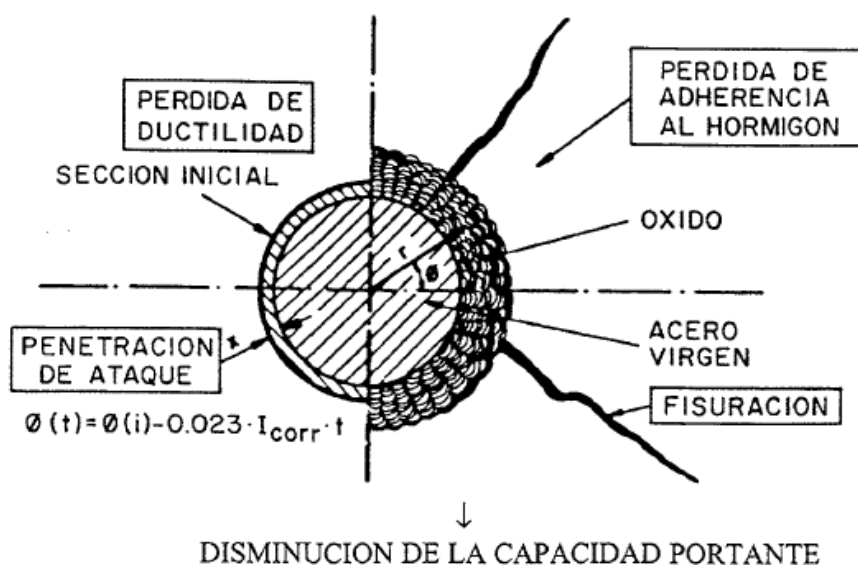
Efectos de la corrosión de la armadura
